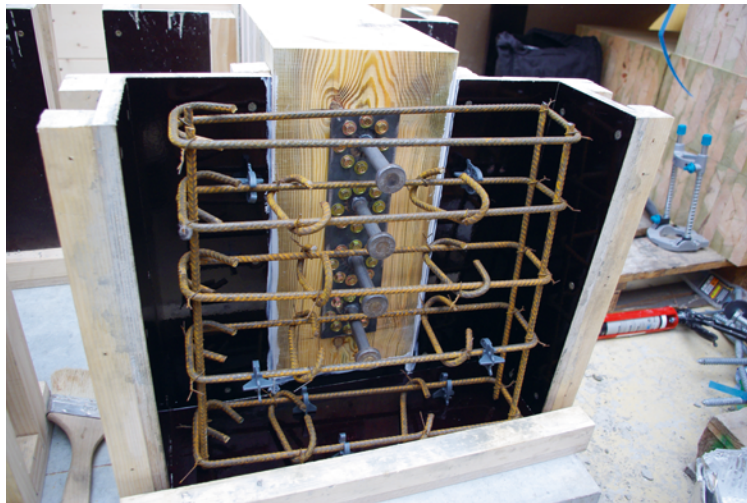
Corps d'épreuve de l'essai push-out. Vue du ferrailage et du connecteur semi-continu avant bétonnage. La photo montre une variante avec 8 tirefonds par connecteur Nelson, l'essai standard étant avec 4 tirefonds
